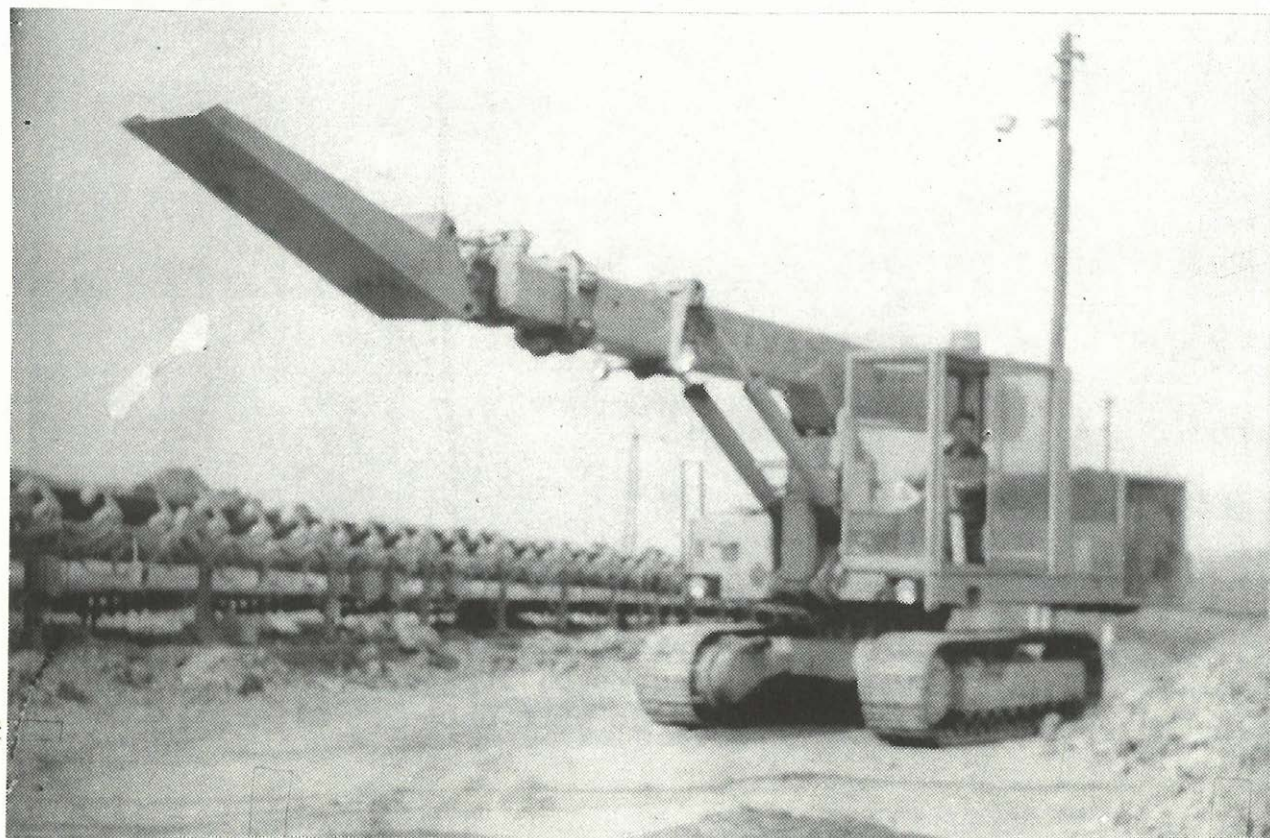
Hydraulické rypadlo CASTOR 602 na skryvkovém
